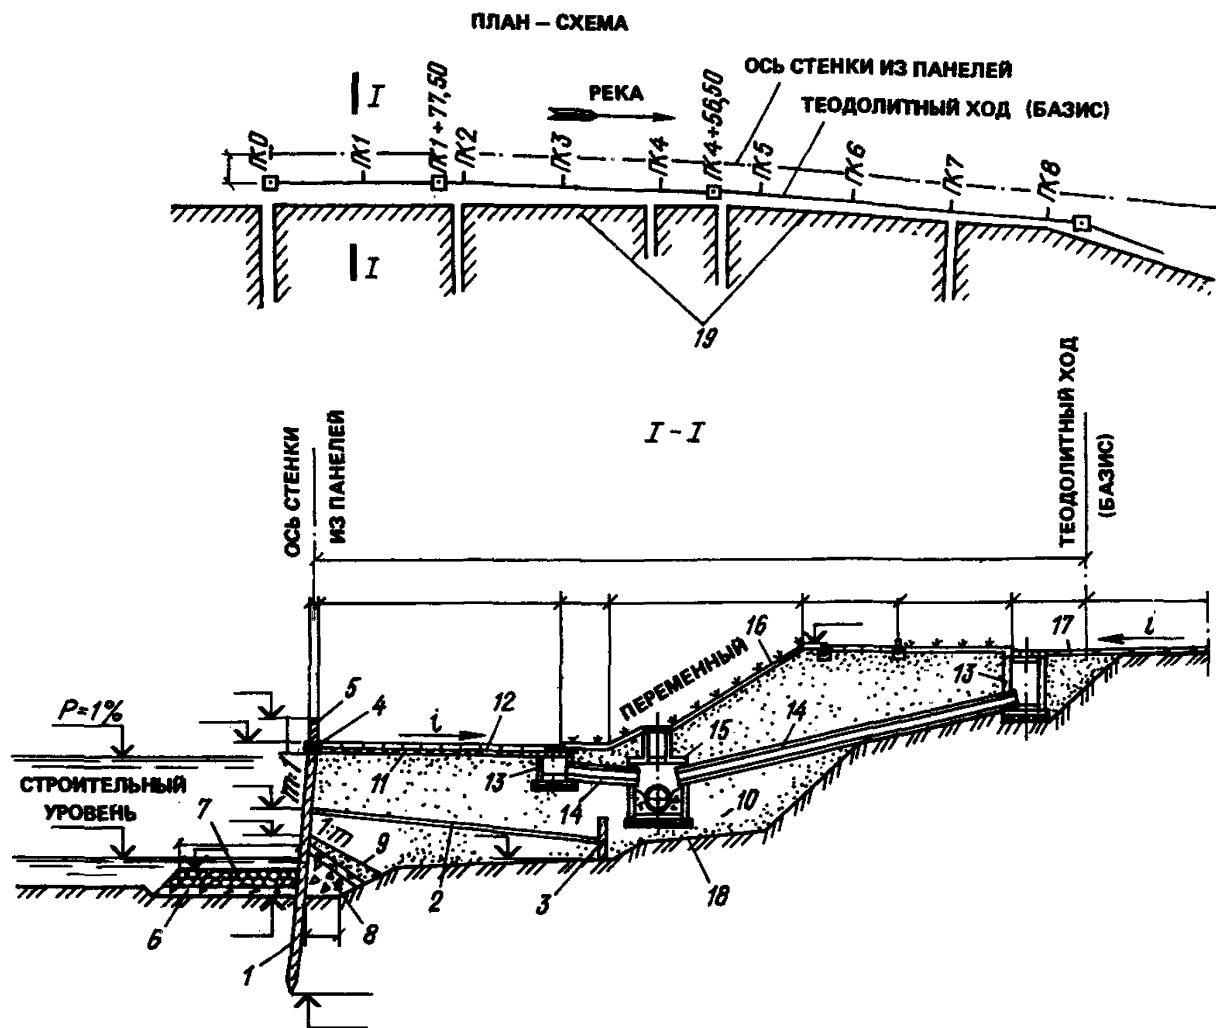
Набережная с вертикальной стенкой из железобетонных панелей
